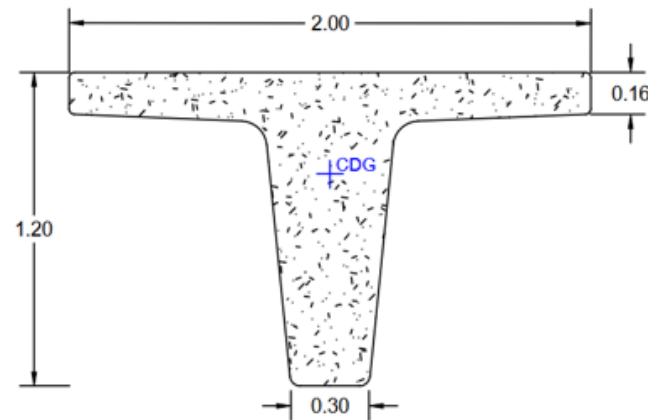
Sección de hormigón pretensado. Fuente: Elaboración propia.
